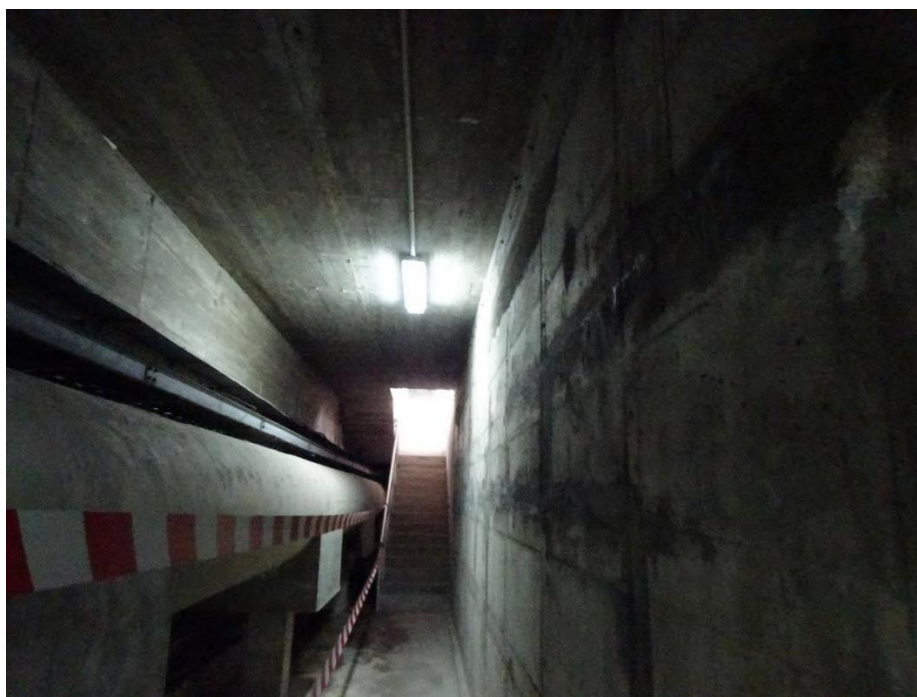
Acceso a la galería de cables desde el centro de control
